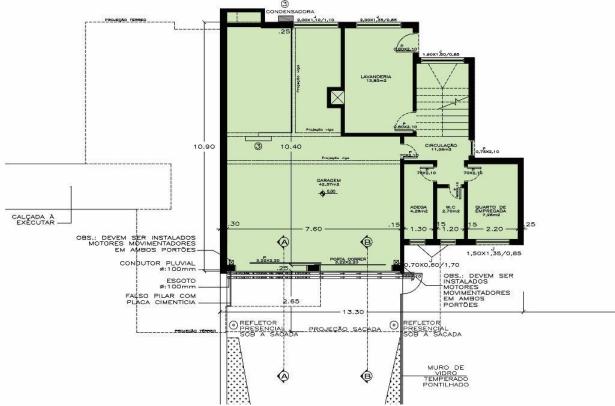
Planta baixa subsolo. Fonte: Nr Arquitetos.
